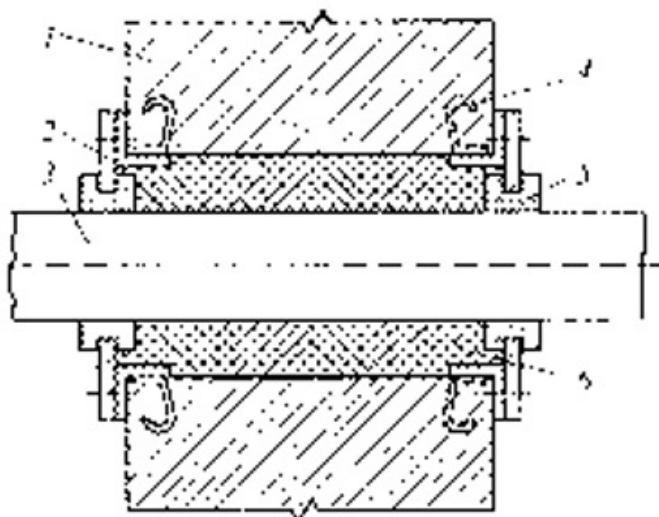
Устройство для виброизоляции трубопроводов при их проходе через стену: 1 — стена или перекрытие; 2 — разрезной фланец; 3 — трубопровод; 4 — эластичная прокладка; 5 — обрамление проема (угловая сталь); 6 — пористый материал
